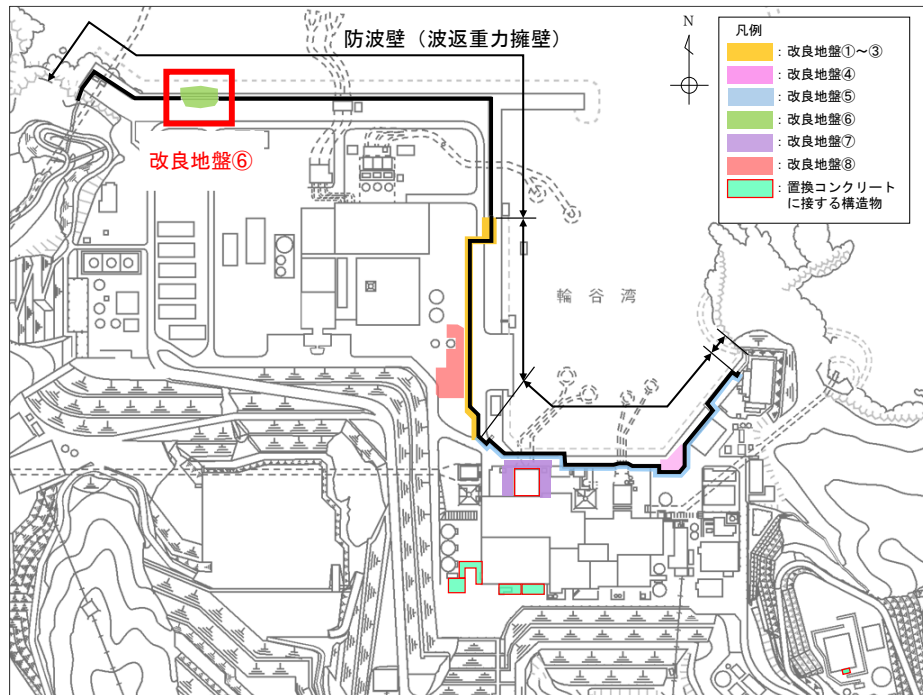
改良地盤を設置する施設の平面配置図
